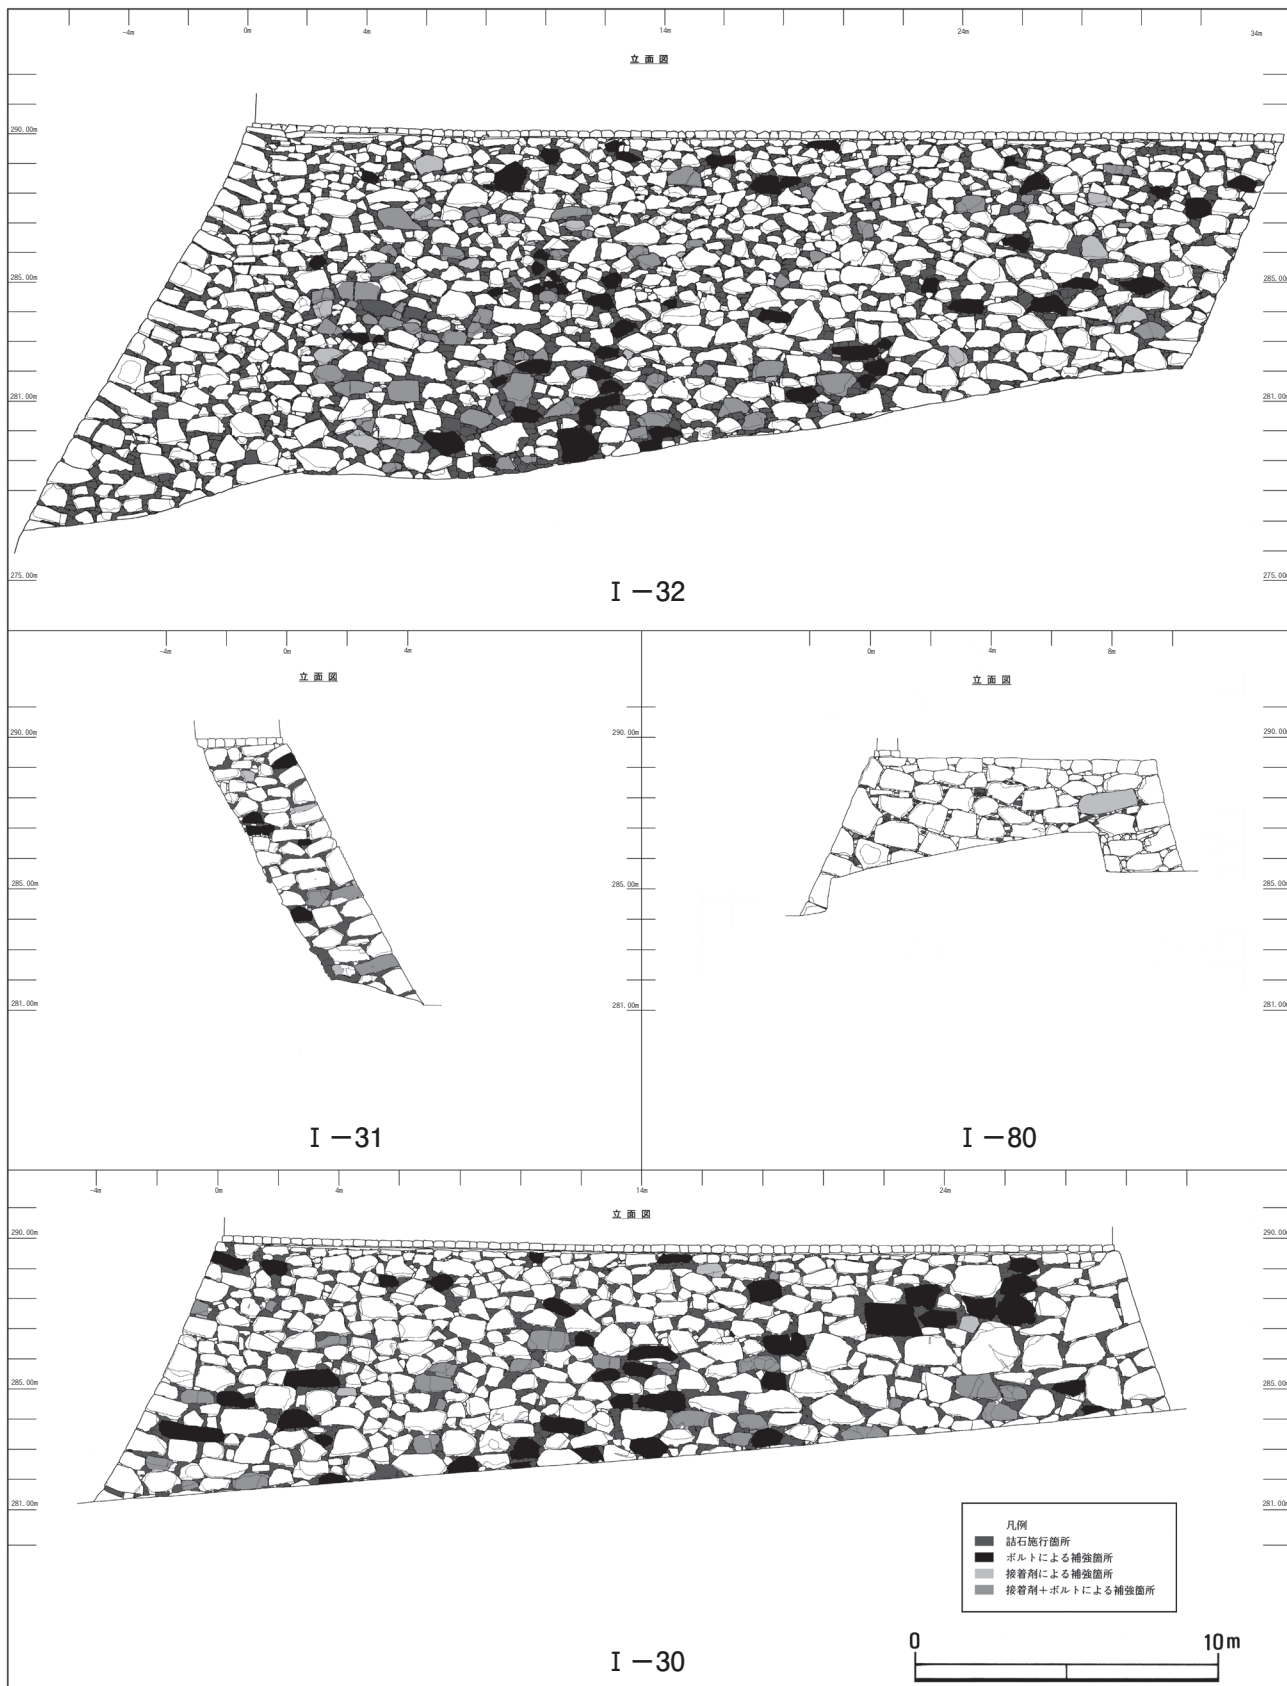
稻荷曲輪北面・西面石垣の施工立面図
